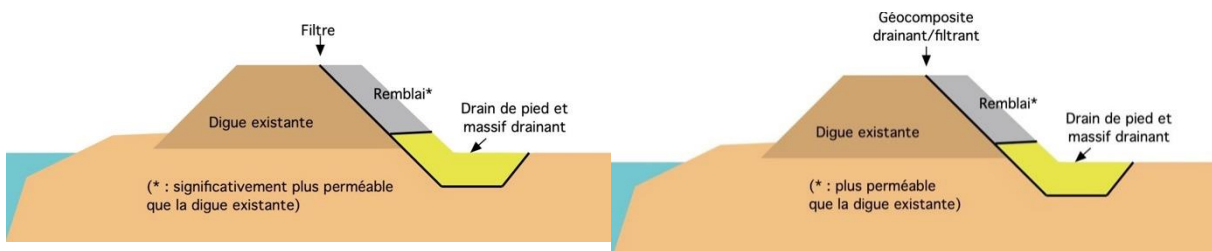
Drain de pied du remblai et massif drainant en fondation (Schéma R.Tourment)
